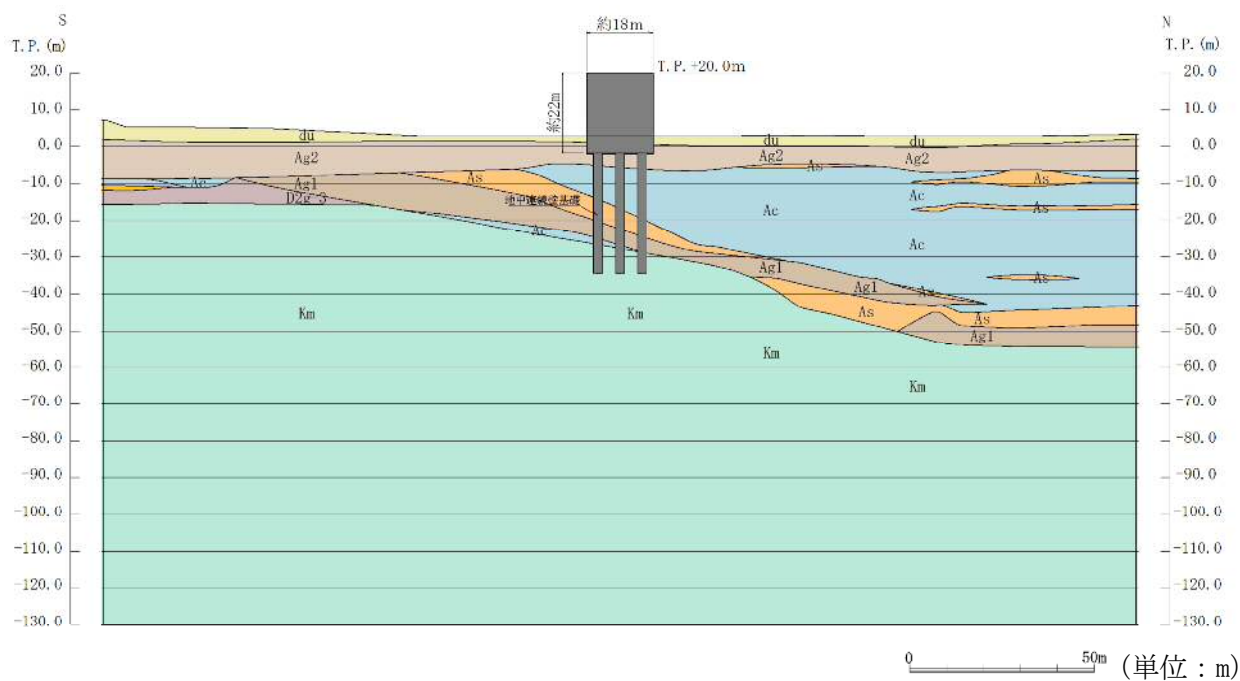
(3) 鉄筋コンクリート防潮壁 評価対象断面図 (③-③断面)
